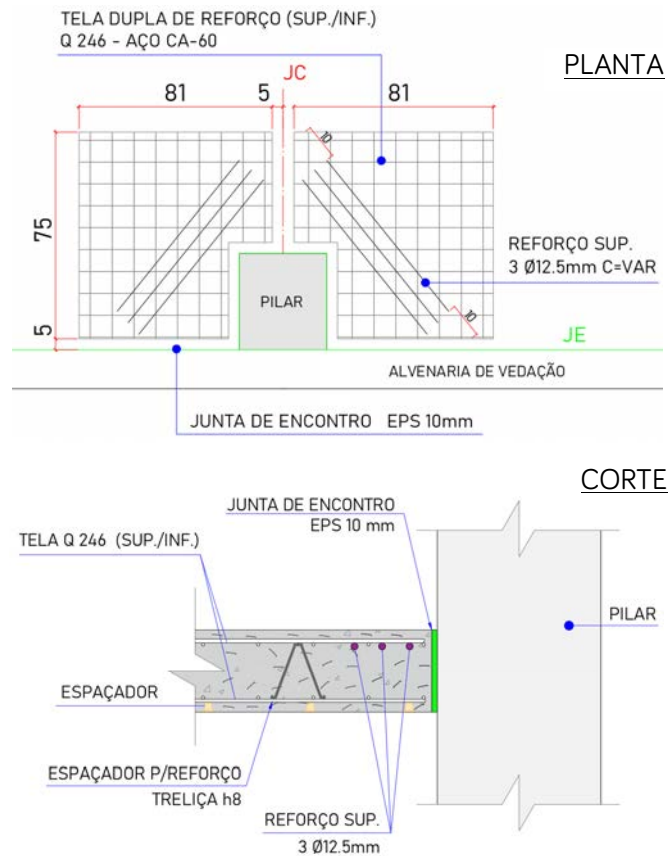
Reforço estrutural na região de pilares (planta e corte). Fonte: Elaborado pelo Autor
